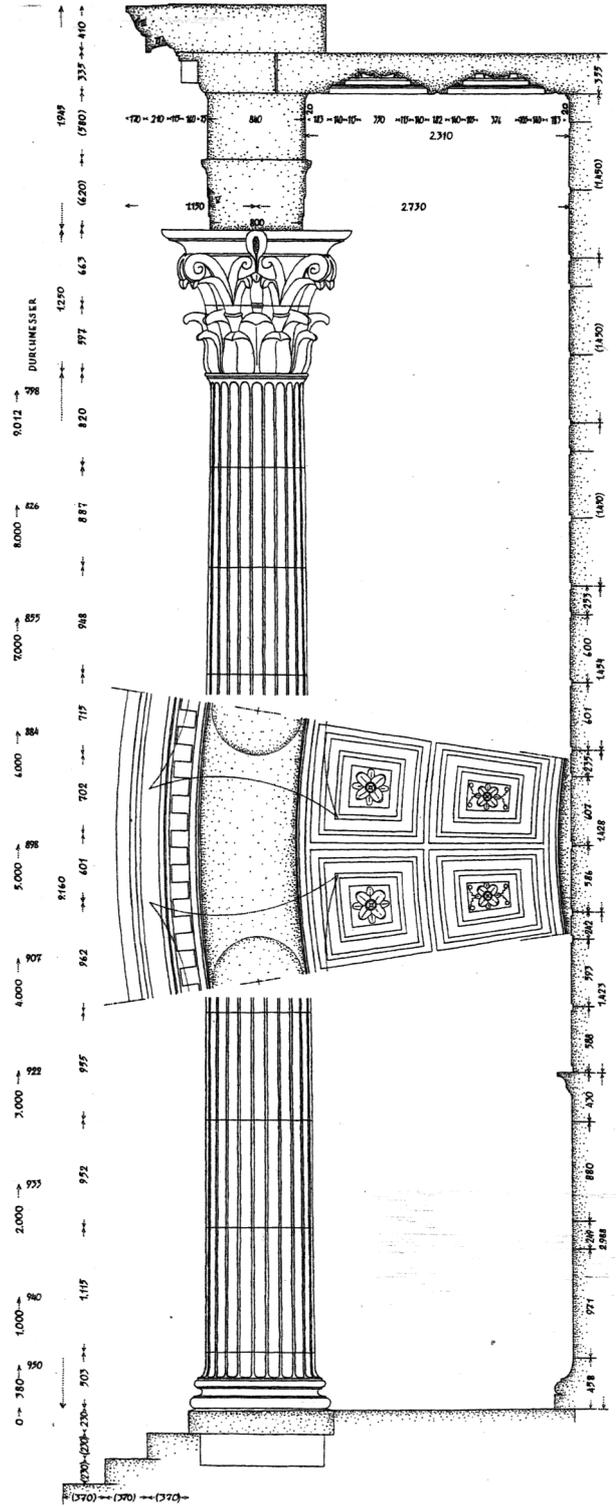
Roma. Tempio rotondo del Foro Boario. Sezione trasversale ricostruttiva della peristasi e pianta di un settore del soffitto (RAKOB – HEILMEYER 1973)
